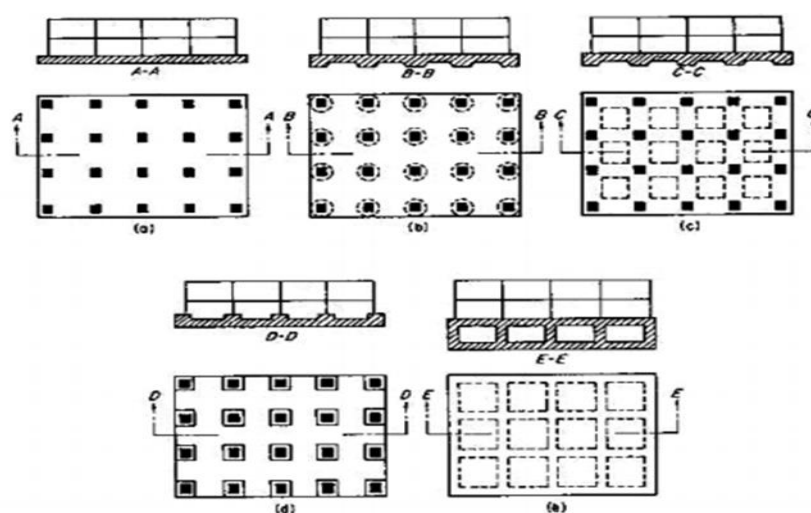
Quelques types courants de fondation sur radier : (a) Radier-dalle, (b) radier à dalle sur socles, (c) radier nervurer, (d) radier à dalle sous socles, (e) radier cellulaire ou caisson [44]
